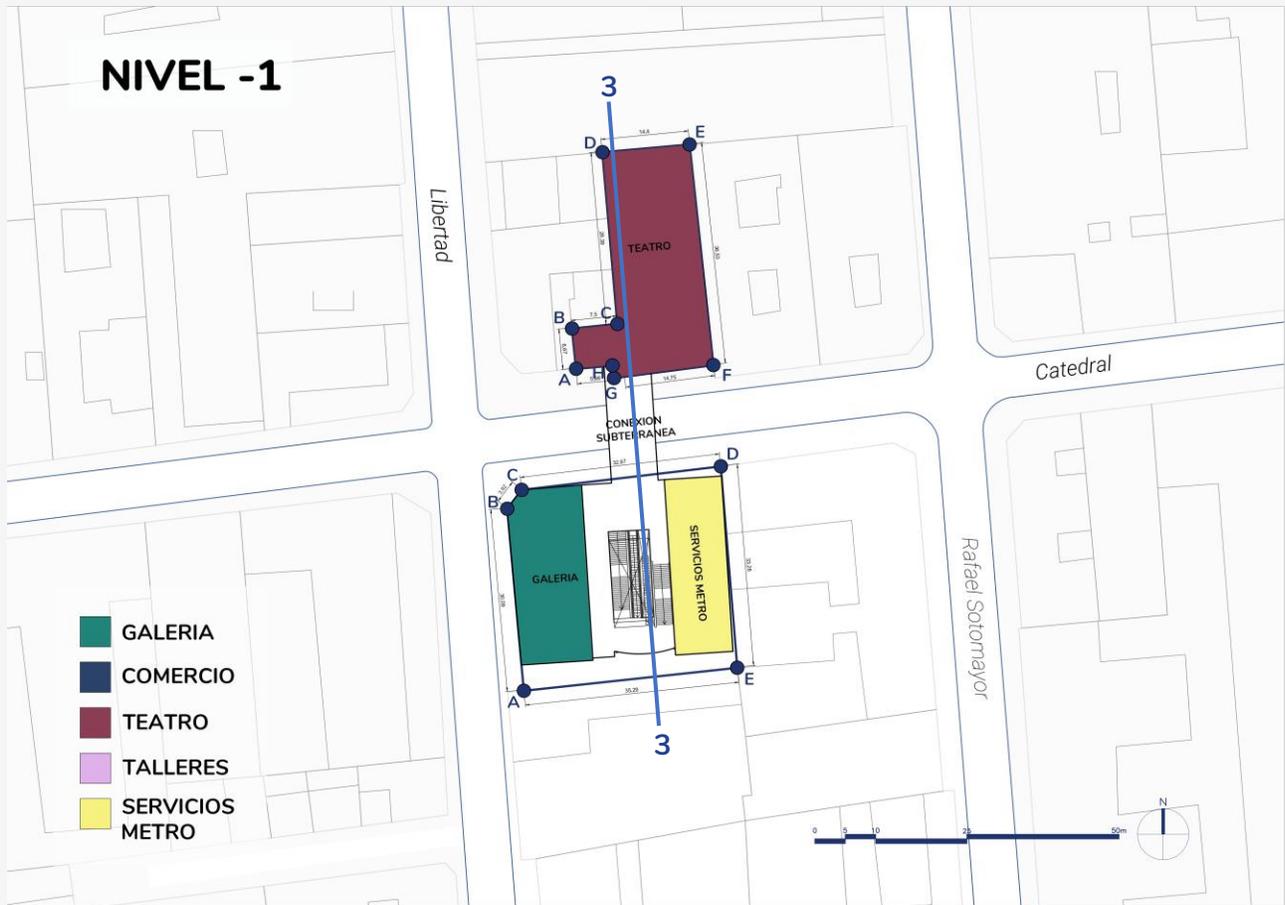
Planta nivel -1 Fuente: Elaboración propia.
